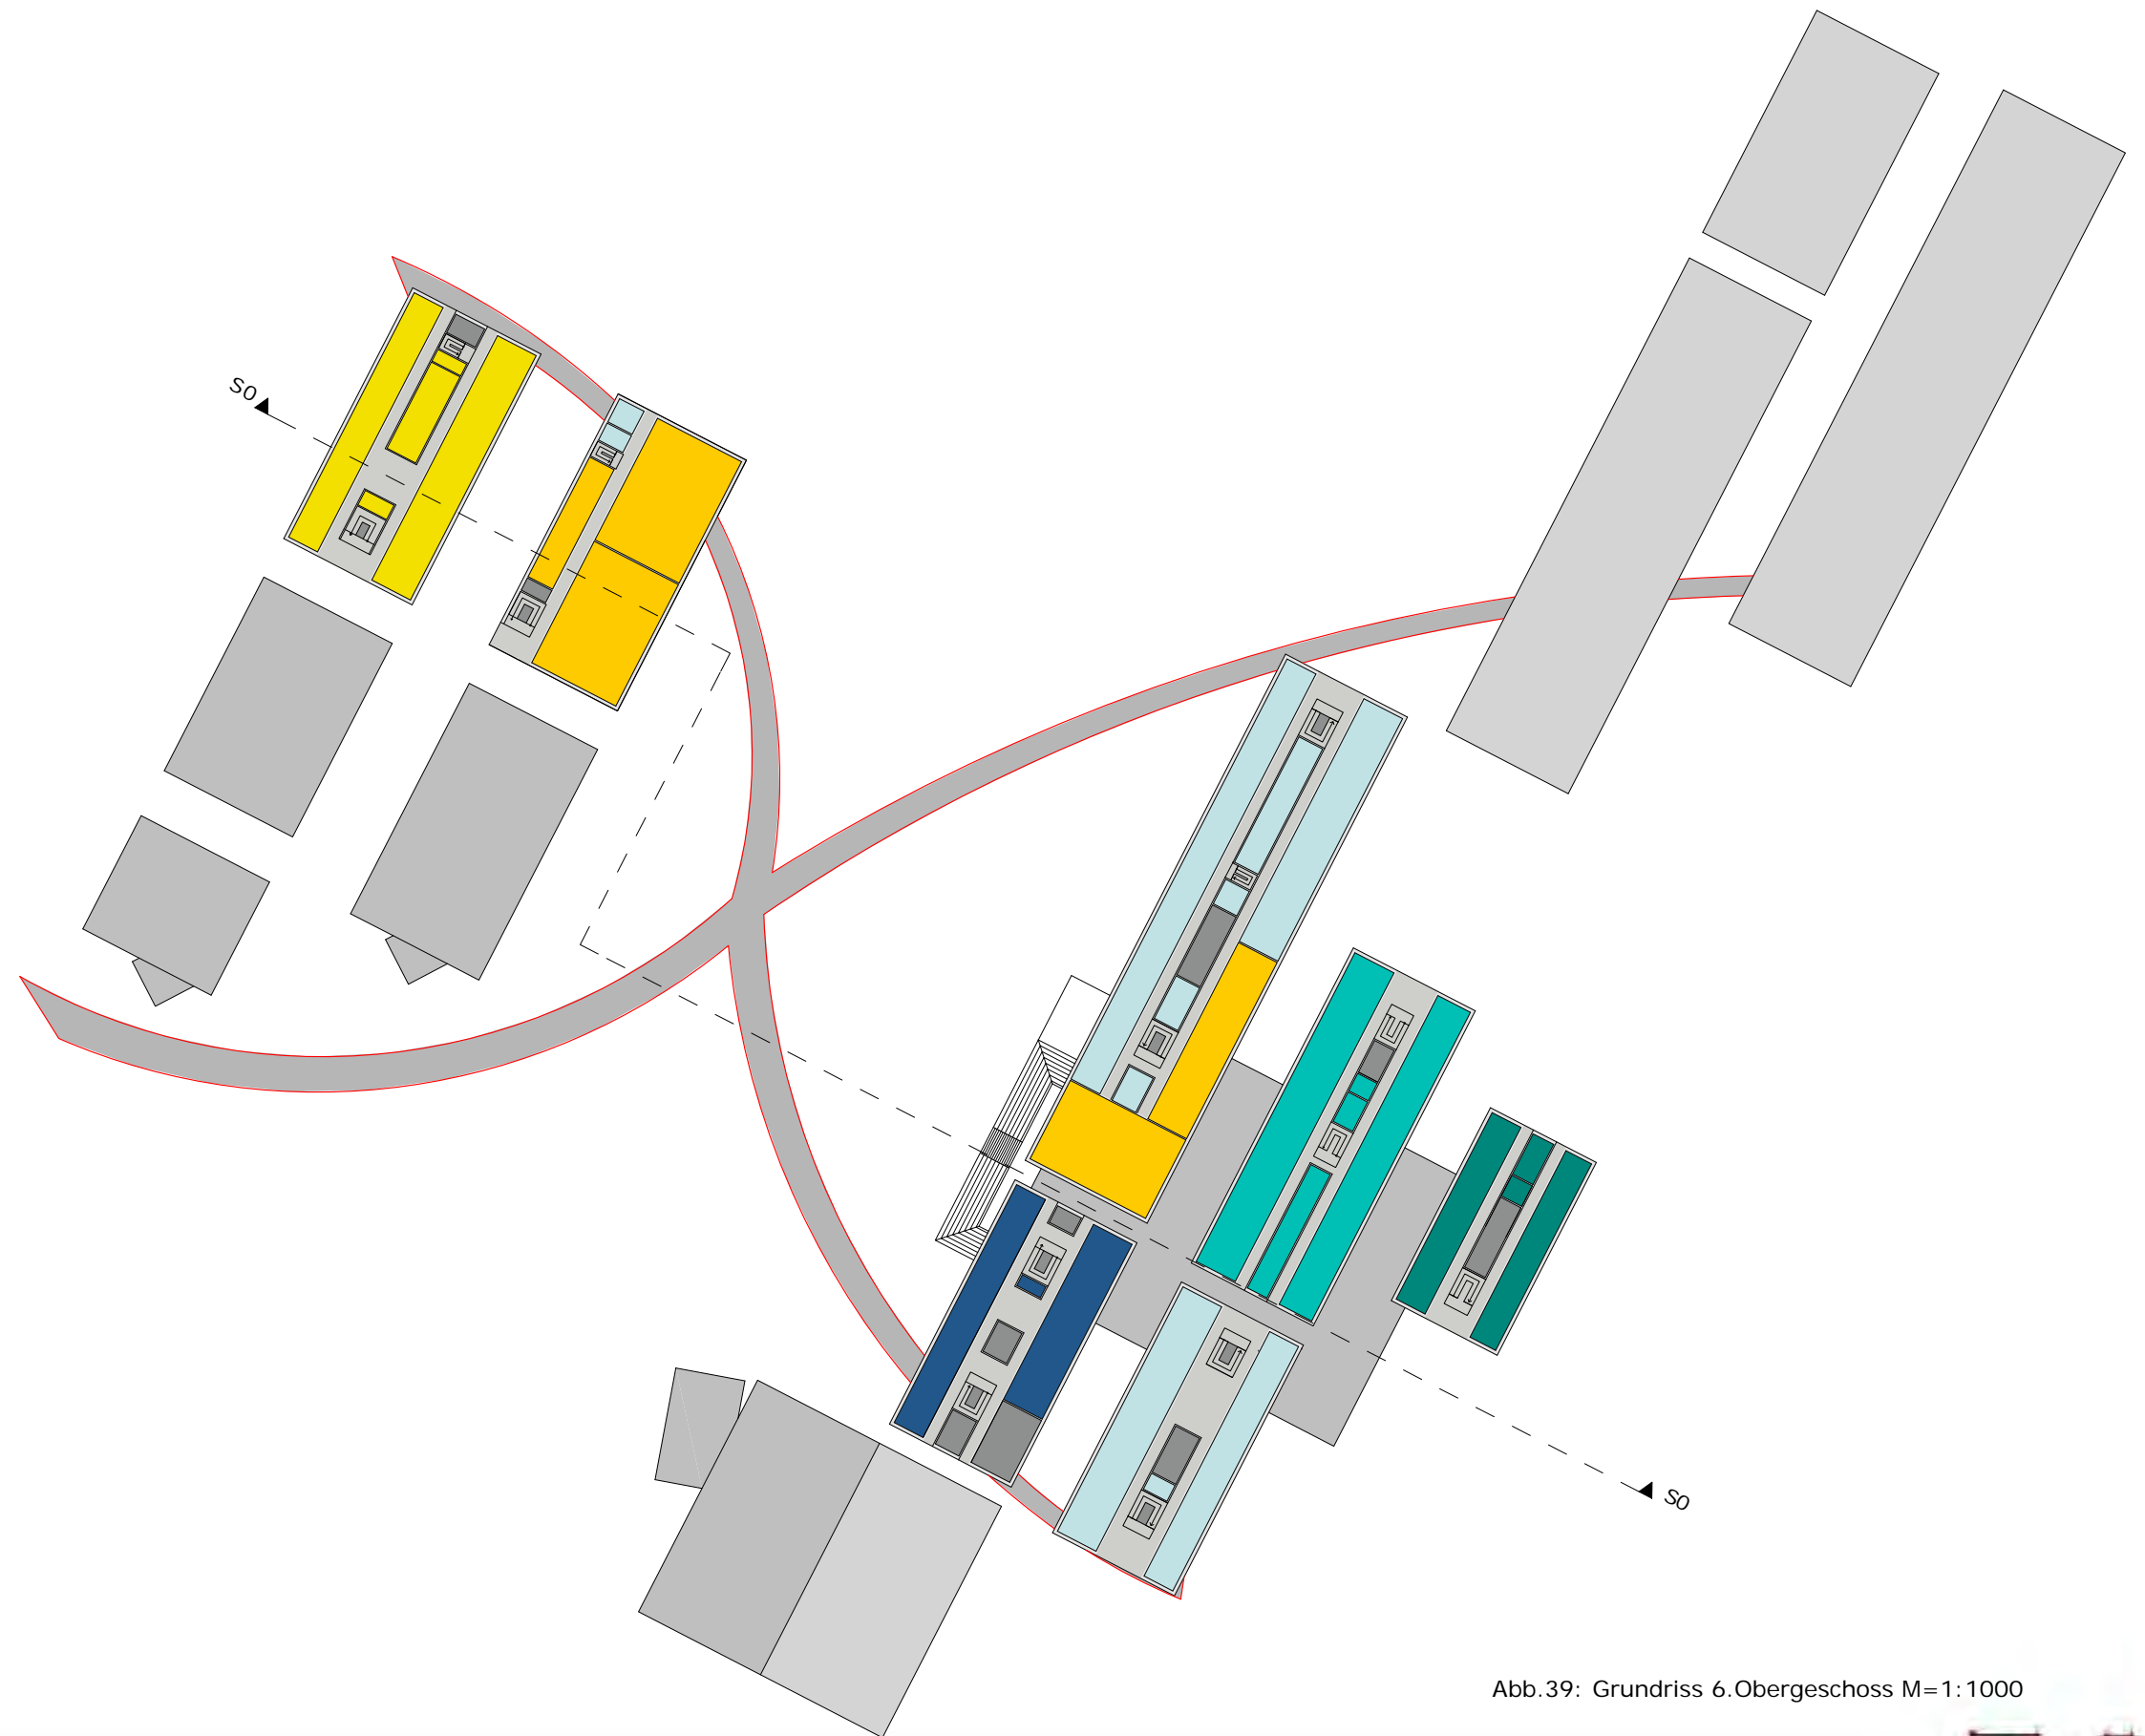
Grundriss 6.Obergeschoss M=1:1000
